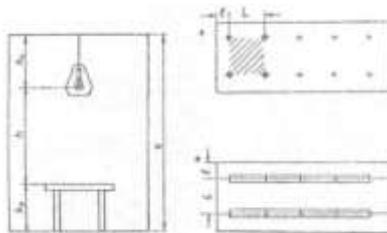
Размеры определяющие установку светильников в помещении
